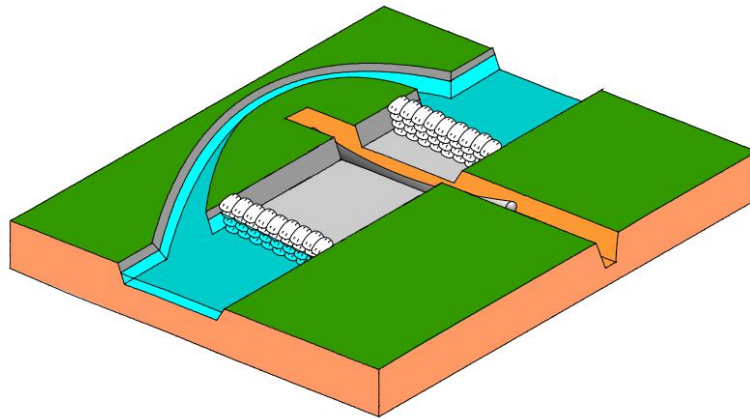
围堰导流开挖管沟法施工断面示意图
